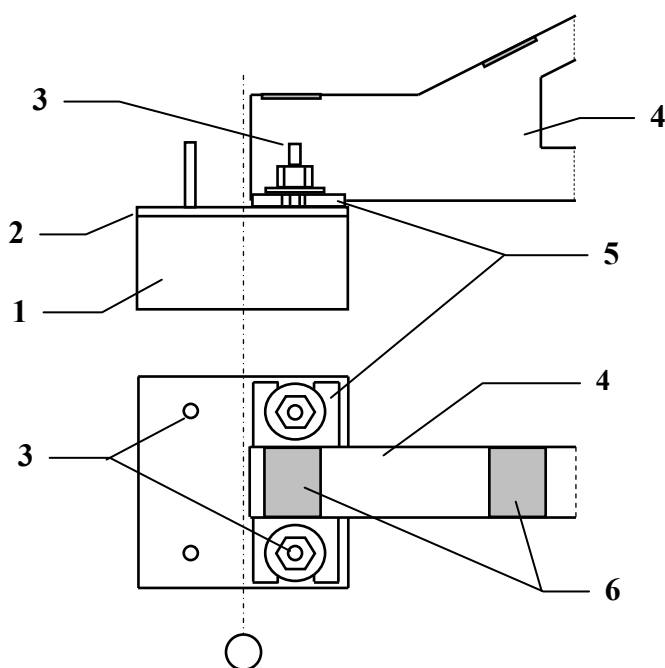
Приклад встановлення залізобетонної кроквяної ферми (балки) на колону:
